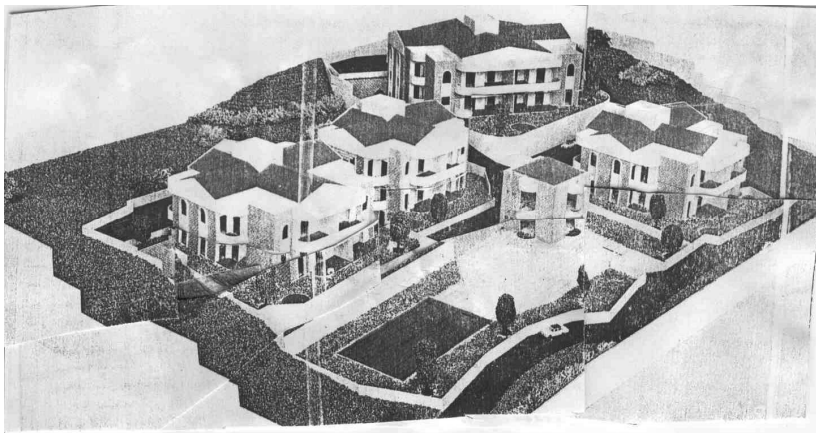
Жилой комплекс «Village of princess Jizal» малоэтажных зданий в Ливане
